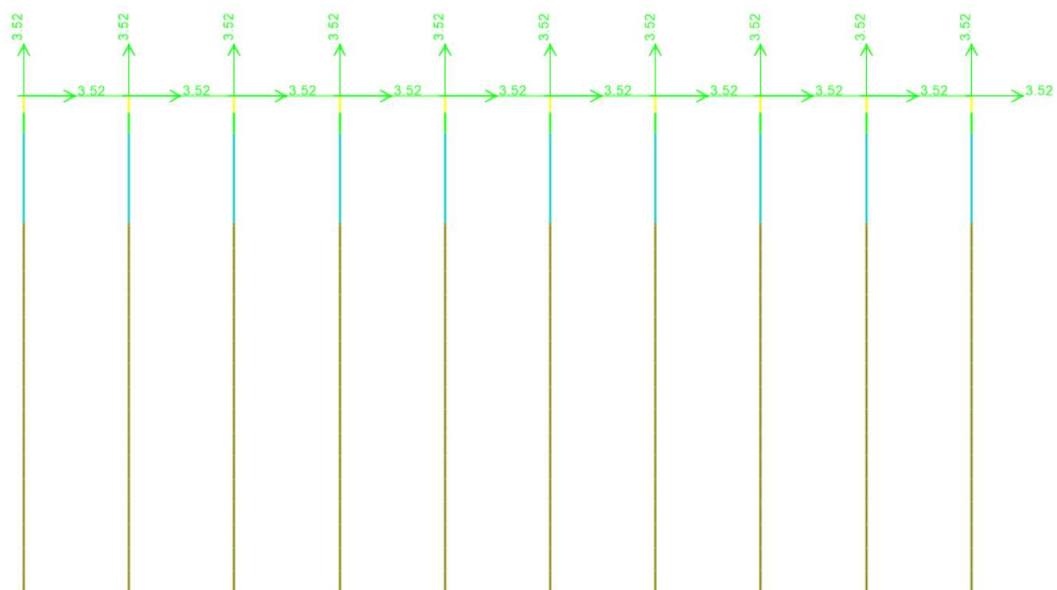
Joint Masses de pilotes verticales - Eje F (3.52 kN-s²/m)
